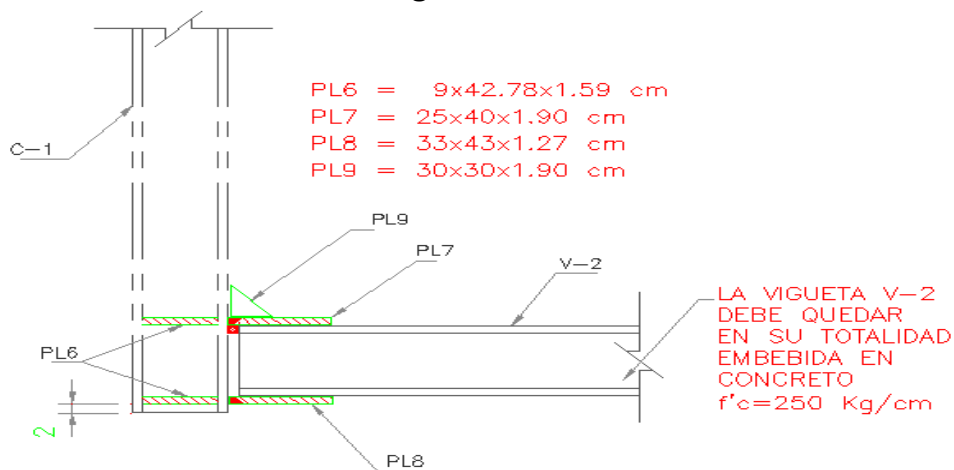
Conexión viga V-2 a columna C-1 (Placas)
